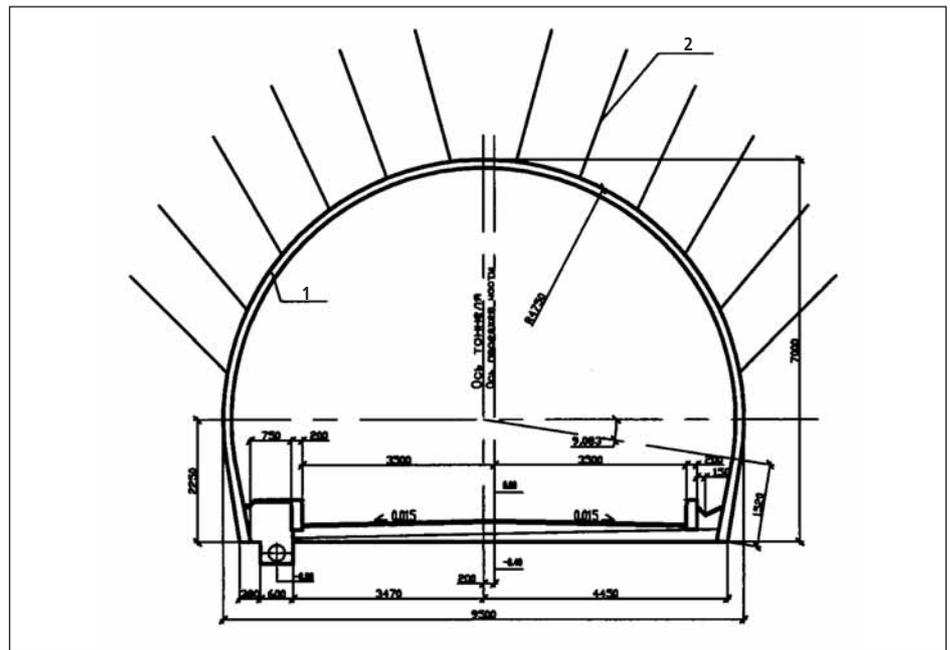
Набрызг-бетонная обделка на участках слаботрециноватых грунтов с коэффициентом крепости не ниже  $f = 5$  при величине сцепления набрызг-бетона с грунтом не ниже  $5 \text{ кг/см}^2$ : 1 – набрызг-бетон; 2 – железобетонные анкеры
